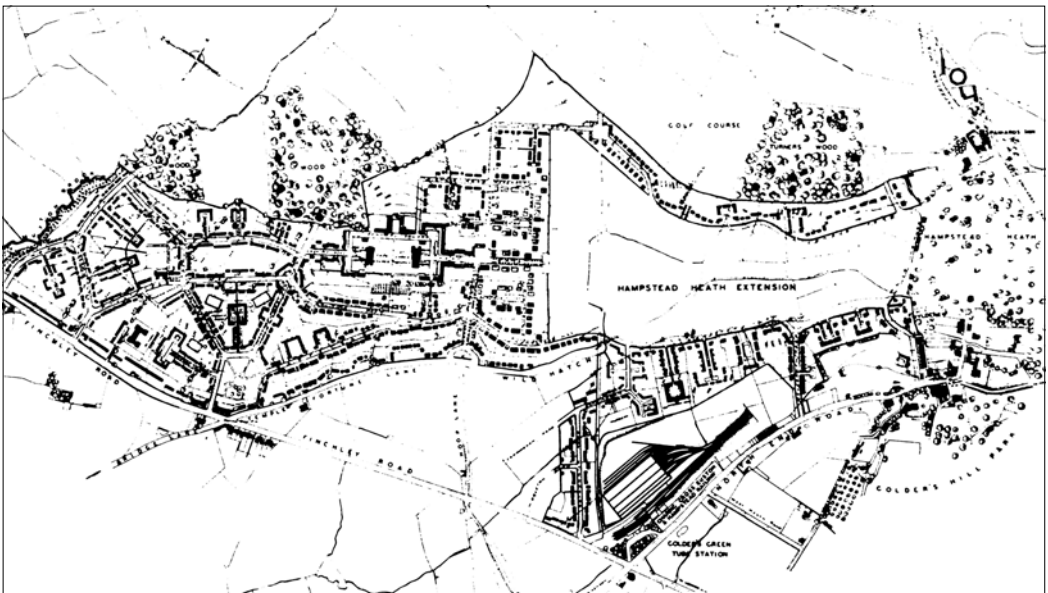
Lageplan der Garten(vor)stadt Hampstead Garden Suburb bei London 1910-11
